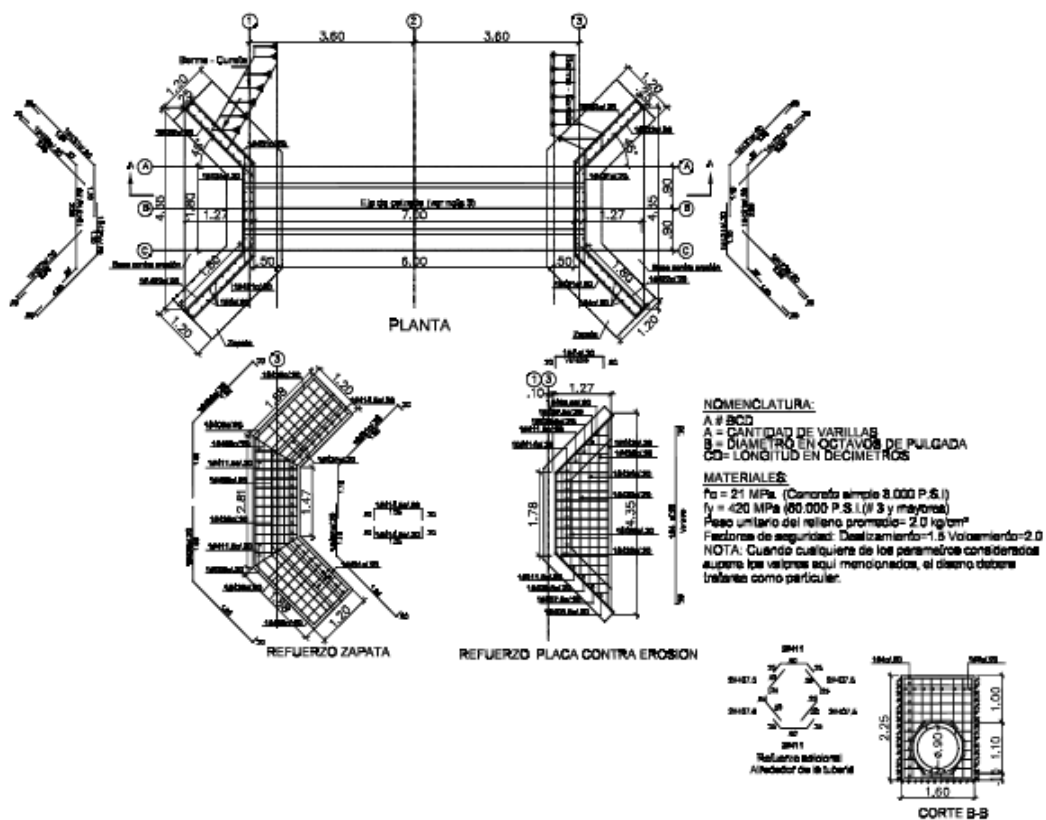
Despiece de acero de la alcantarilla verificado, Fuente: Propia
